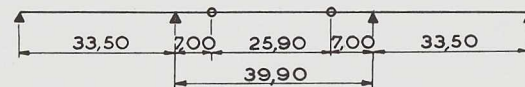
Système constructif des maîtresses-poutres du pont-route de Lustin.
